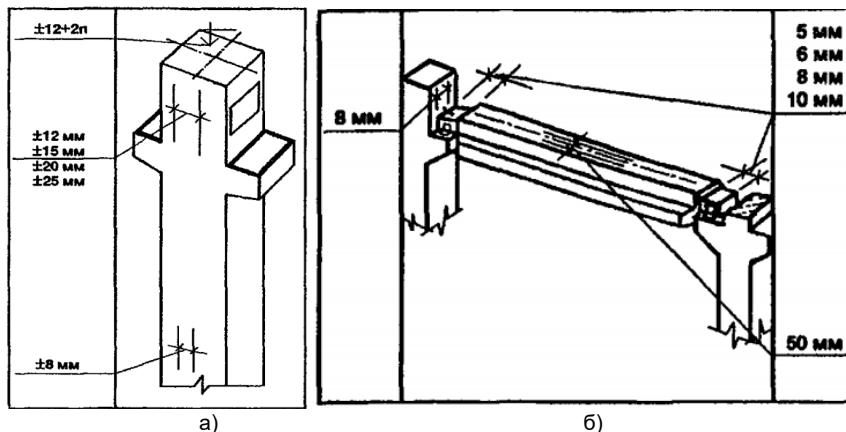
Фрагмент СОКК монтажа сборных железобетонных конструкций
